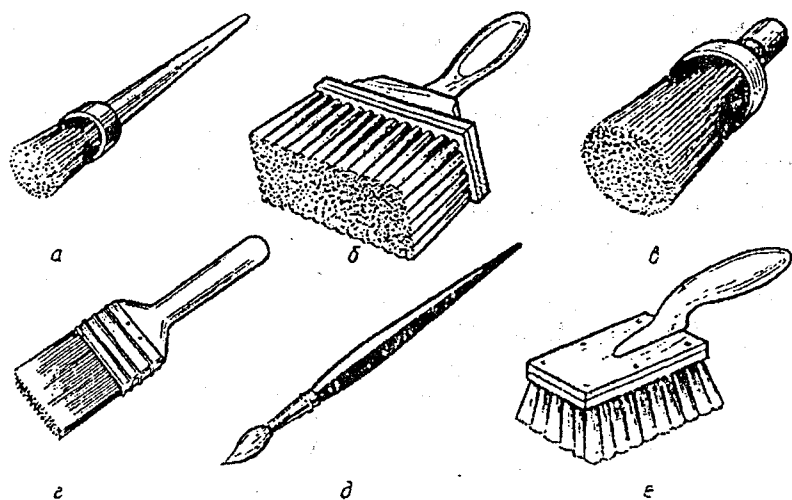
Щітки для малярних і шпалерних робіт: а - щітка-ручник; б - щітка-макловиця; в - махова щітка; г - флейцева щітка; д - фільонкова щітка; е - щітка-торцівка
